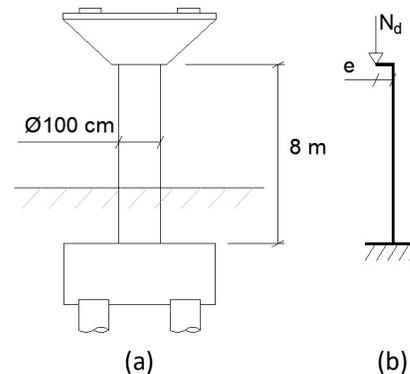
(a) Esquema de corte de la pila y (b) esquema básico estructural del pilar.
